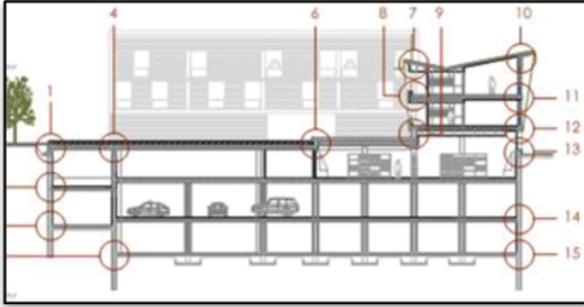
Ejemplo de la solución arquitectónica en forma vertical.
